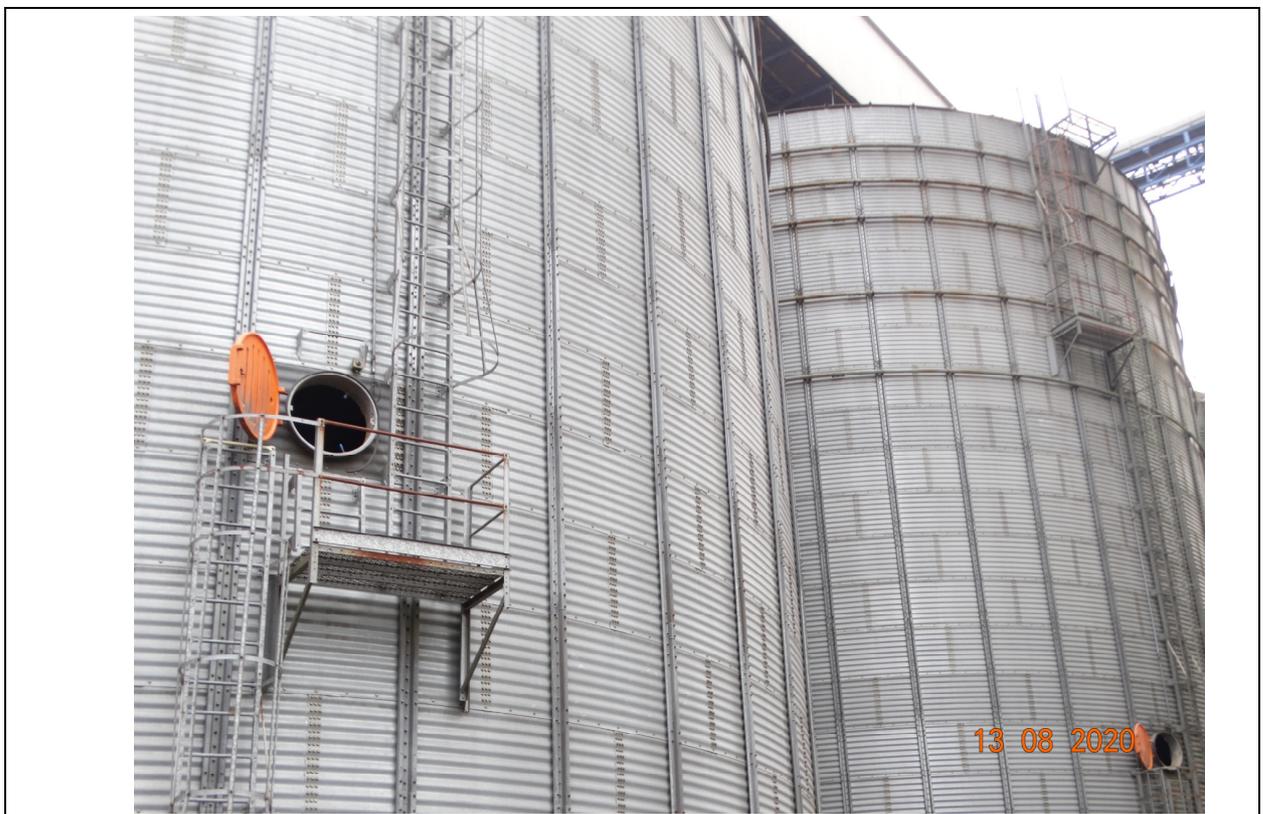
VISTA DOS SILOS METÁLICOS.
